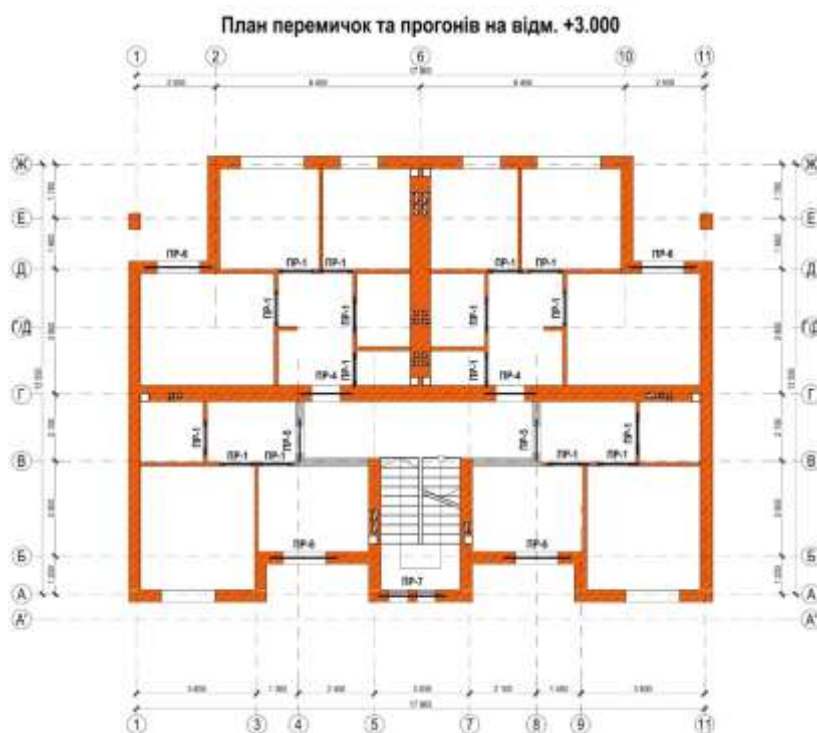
Влаштування перемичок на плані другого поверху секції
